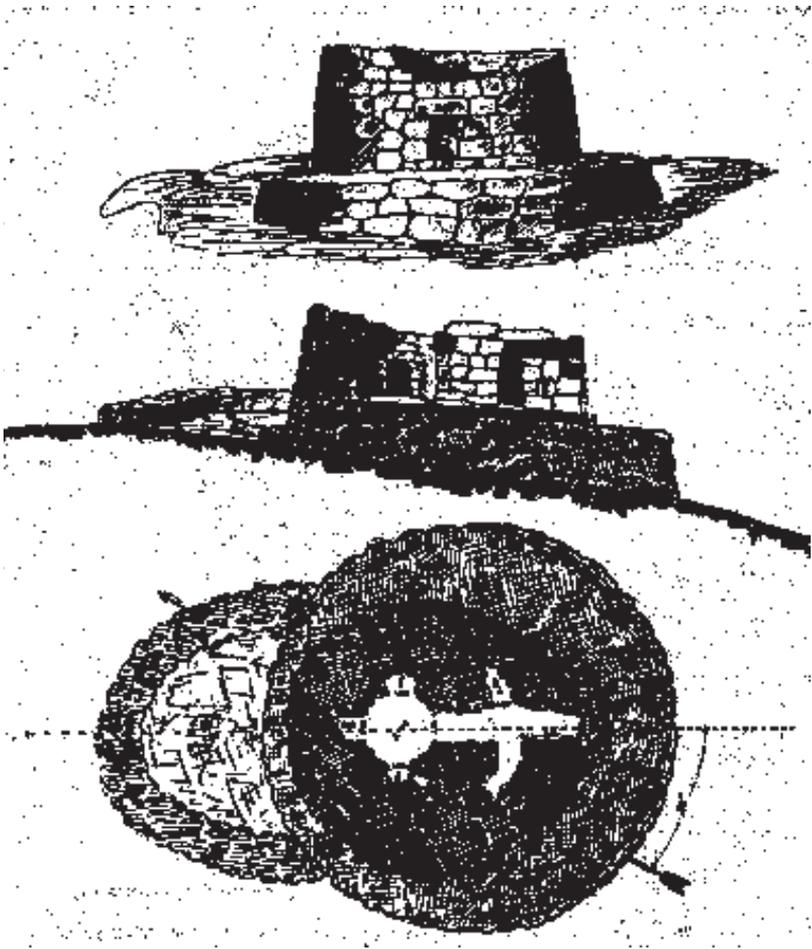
Olmedo, Nuraghe Isfundadu: pianta e sezione (da Pinza, 1901).
